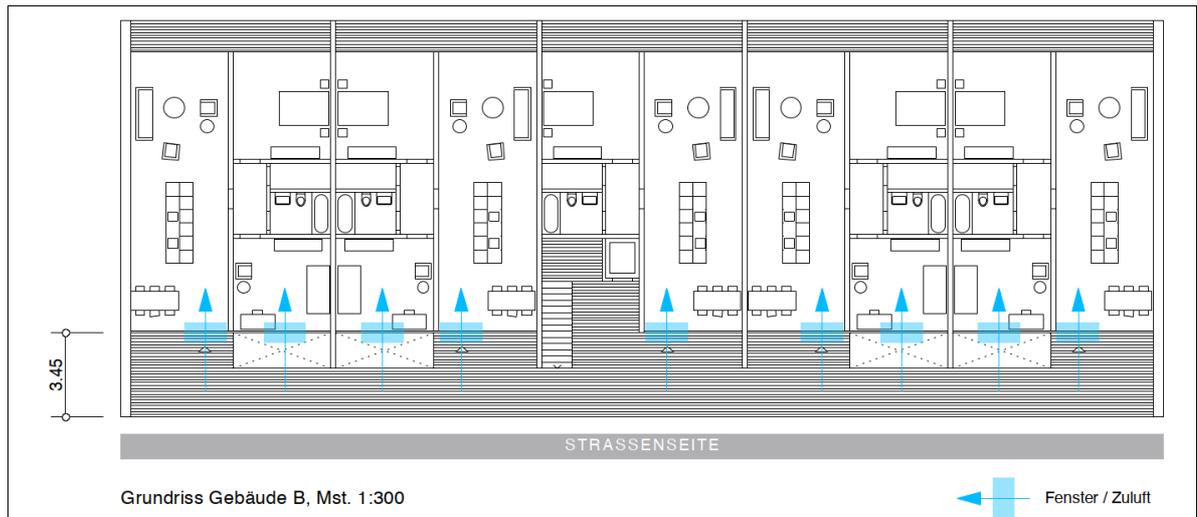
Lärmoptimierter Grundriss Gebäude B Richtprojekt
